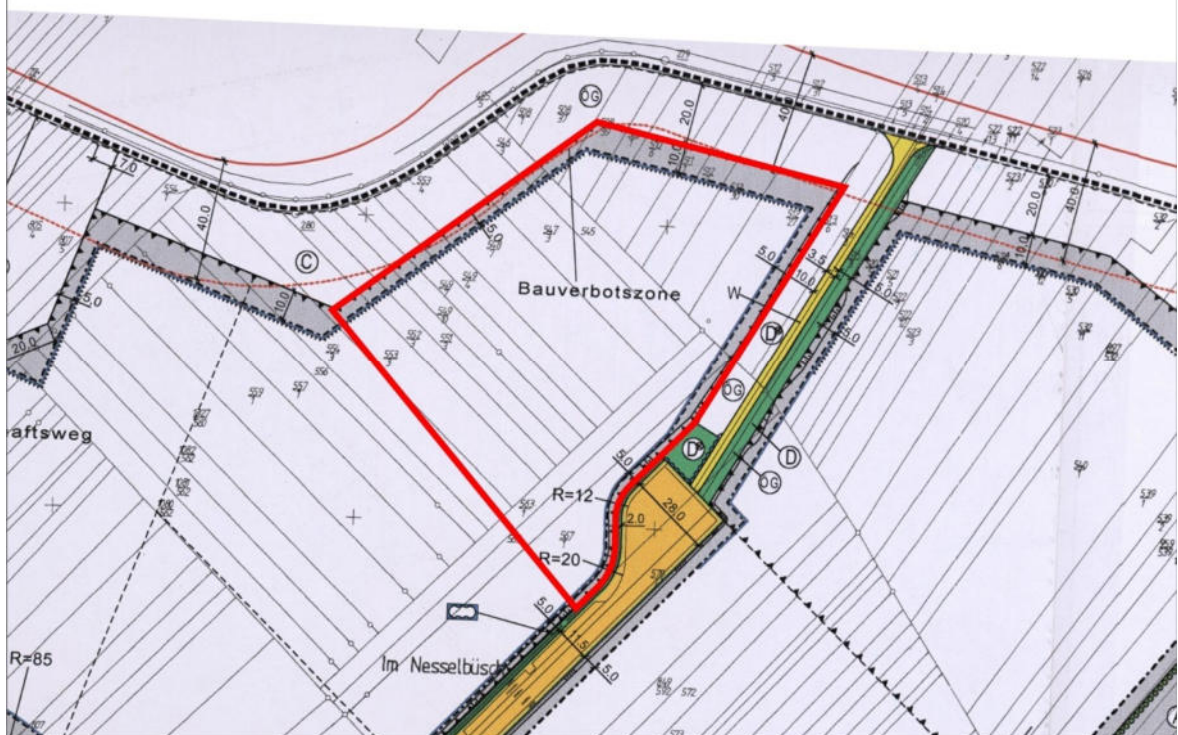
Bebauungsplan „Gewerbe-dreieck an der A 61/L 117, 1. Änderung
